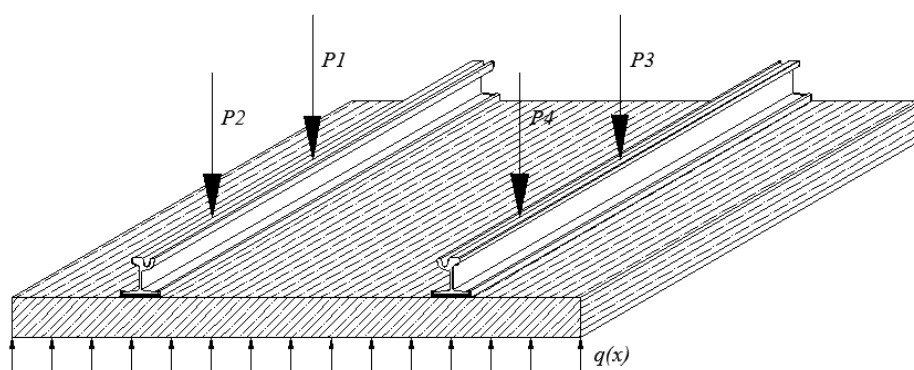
Схема передачи нагрузки на несущее бетонное основание при коэффициенте постели подошвенного вкладыша более 130 МПа/м
